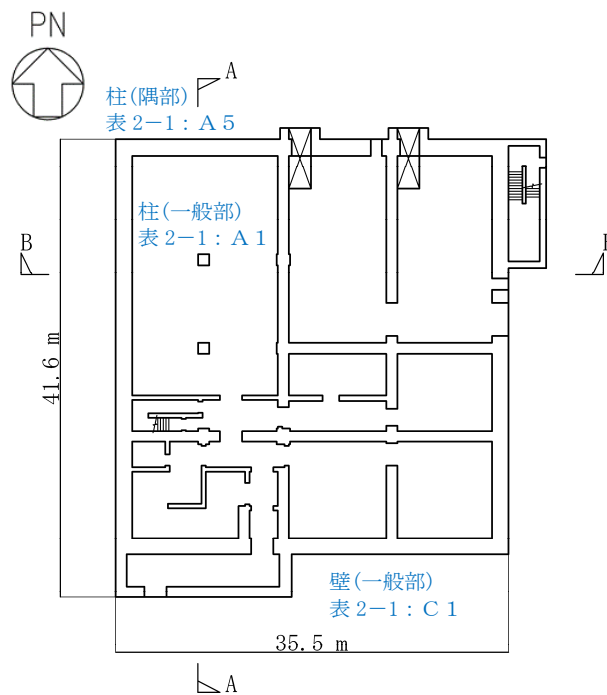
緊急時対策所建屋の概略平面図 (EL. 23.3m)
